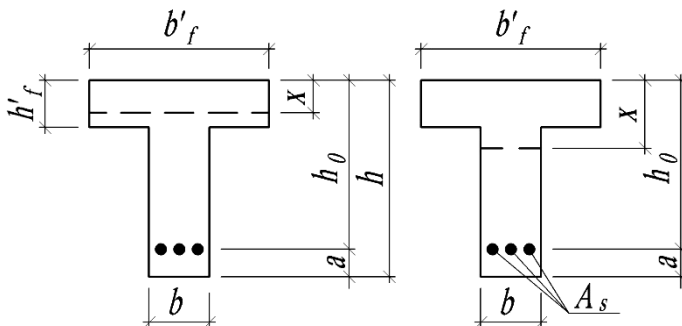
Положение границы сжатой зоны в сечении изгибаемого железобетонного элемента:
